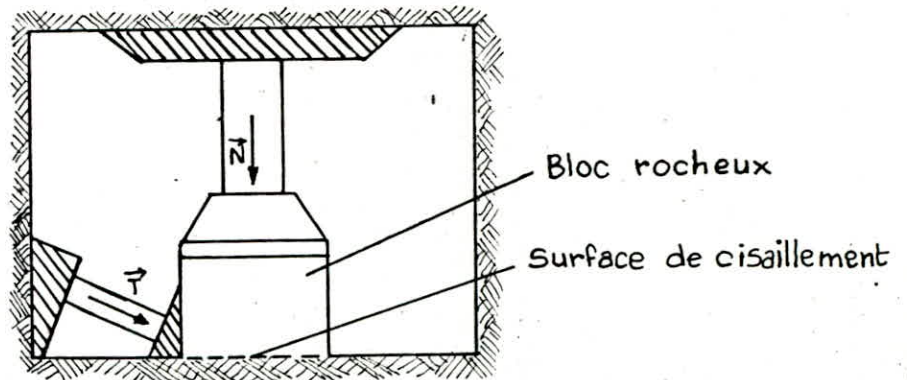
Essai de cisaillement in-situ dans une galerie .
